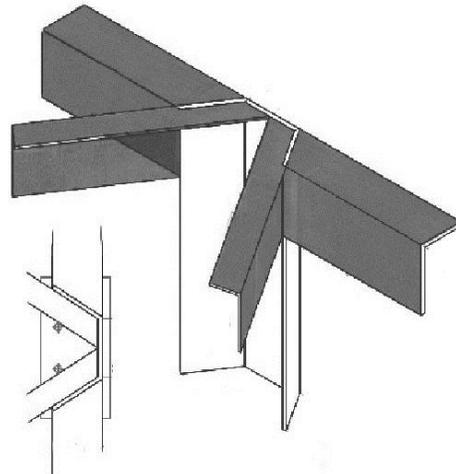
Isométrico estructura unión entre columna y travesaños. Elaboración propia. 2014
